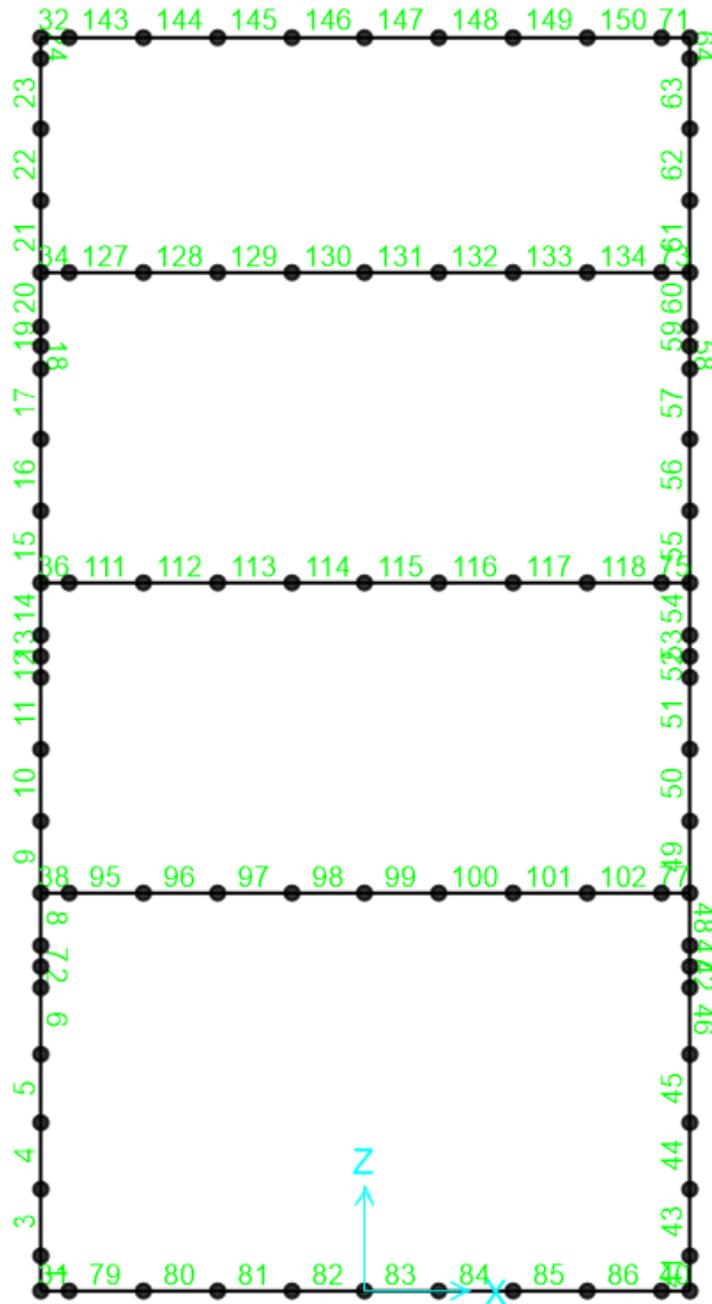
Sezione 1: Schema del modello di calcolo agli elementi finiti: nodi ed elementi frame
